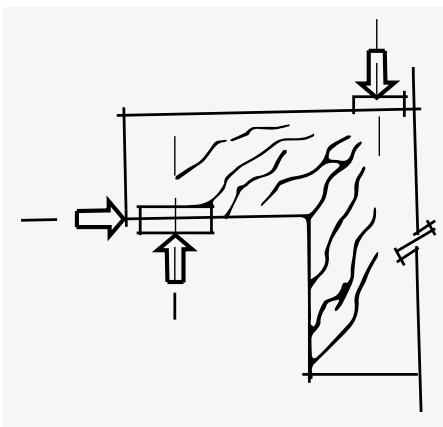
Ejemplo: patrón típico de agrietamiento en apoyo. [11]
